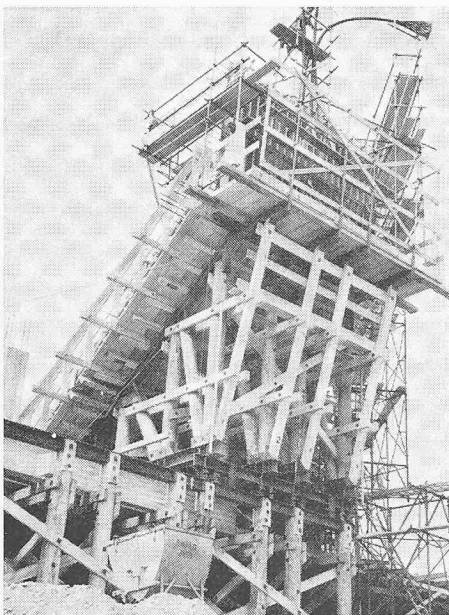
Bauvorgang Hängedach: Betonieretappe von 10 m Breite des Hängedaches aus Leca-Beton, auf einem verschiebbaren Gerüst eingeschalt. Rechts im Bild der aus herkömmlichem Beton vorweg erstellte Dachkranz, links oben der in Dachmitte angeordnete Dilatationsträger
